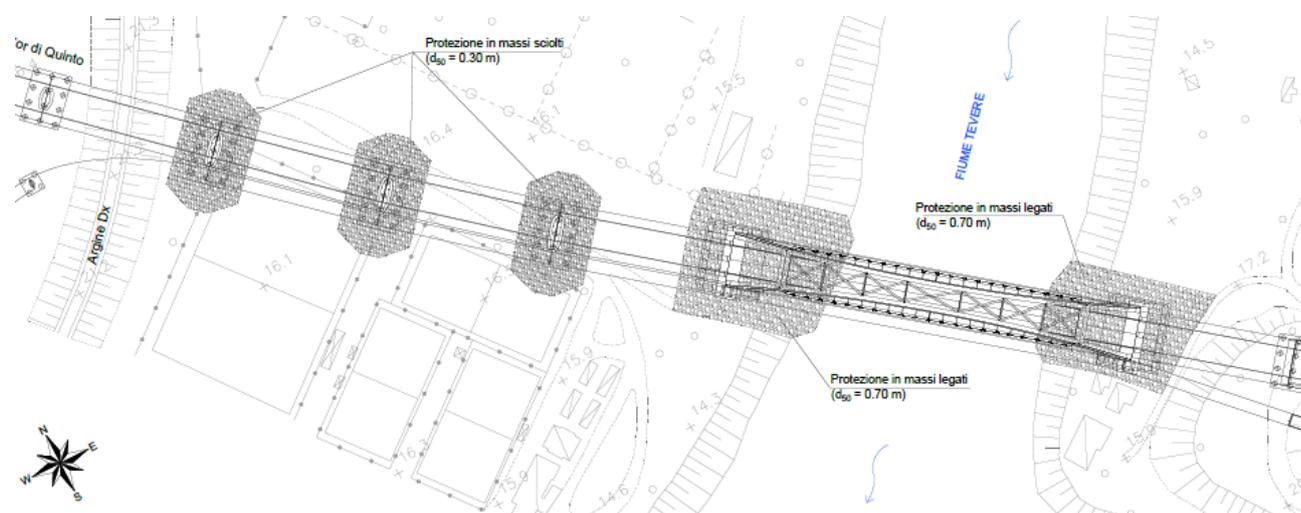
Opere di sistemazione/protezione previste in corrispondenza delle pile del VI04: pianta.
